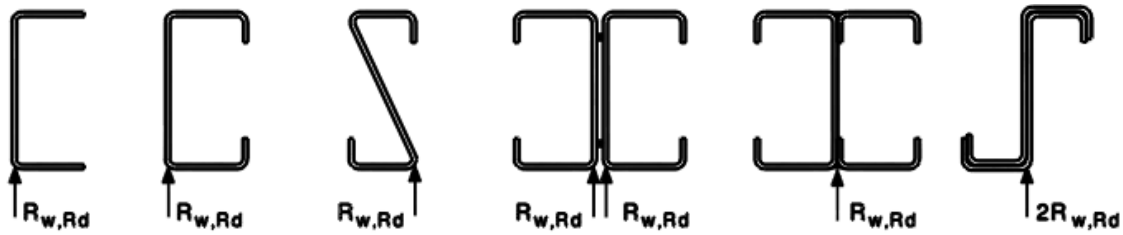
Exemplos de secções transversais com uma única alma [1].
